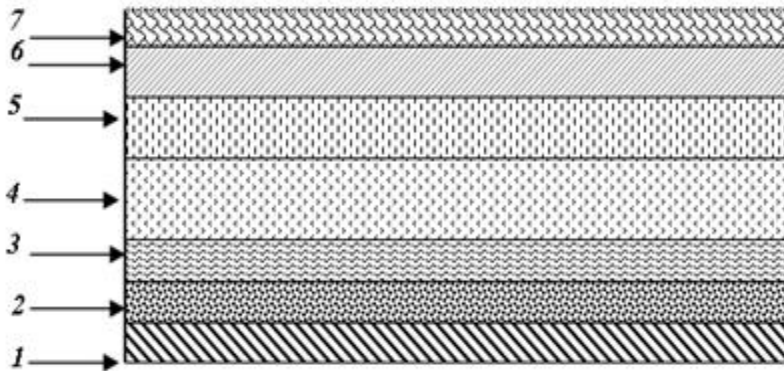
Coupe verticale du plancher terrasse inaccessible
